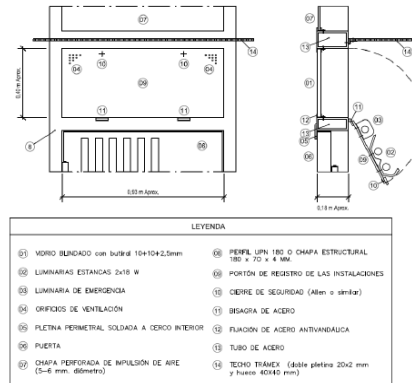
Alzado y perfil de la cámara de instalaciones desde el exterior de la estancia
